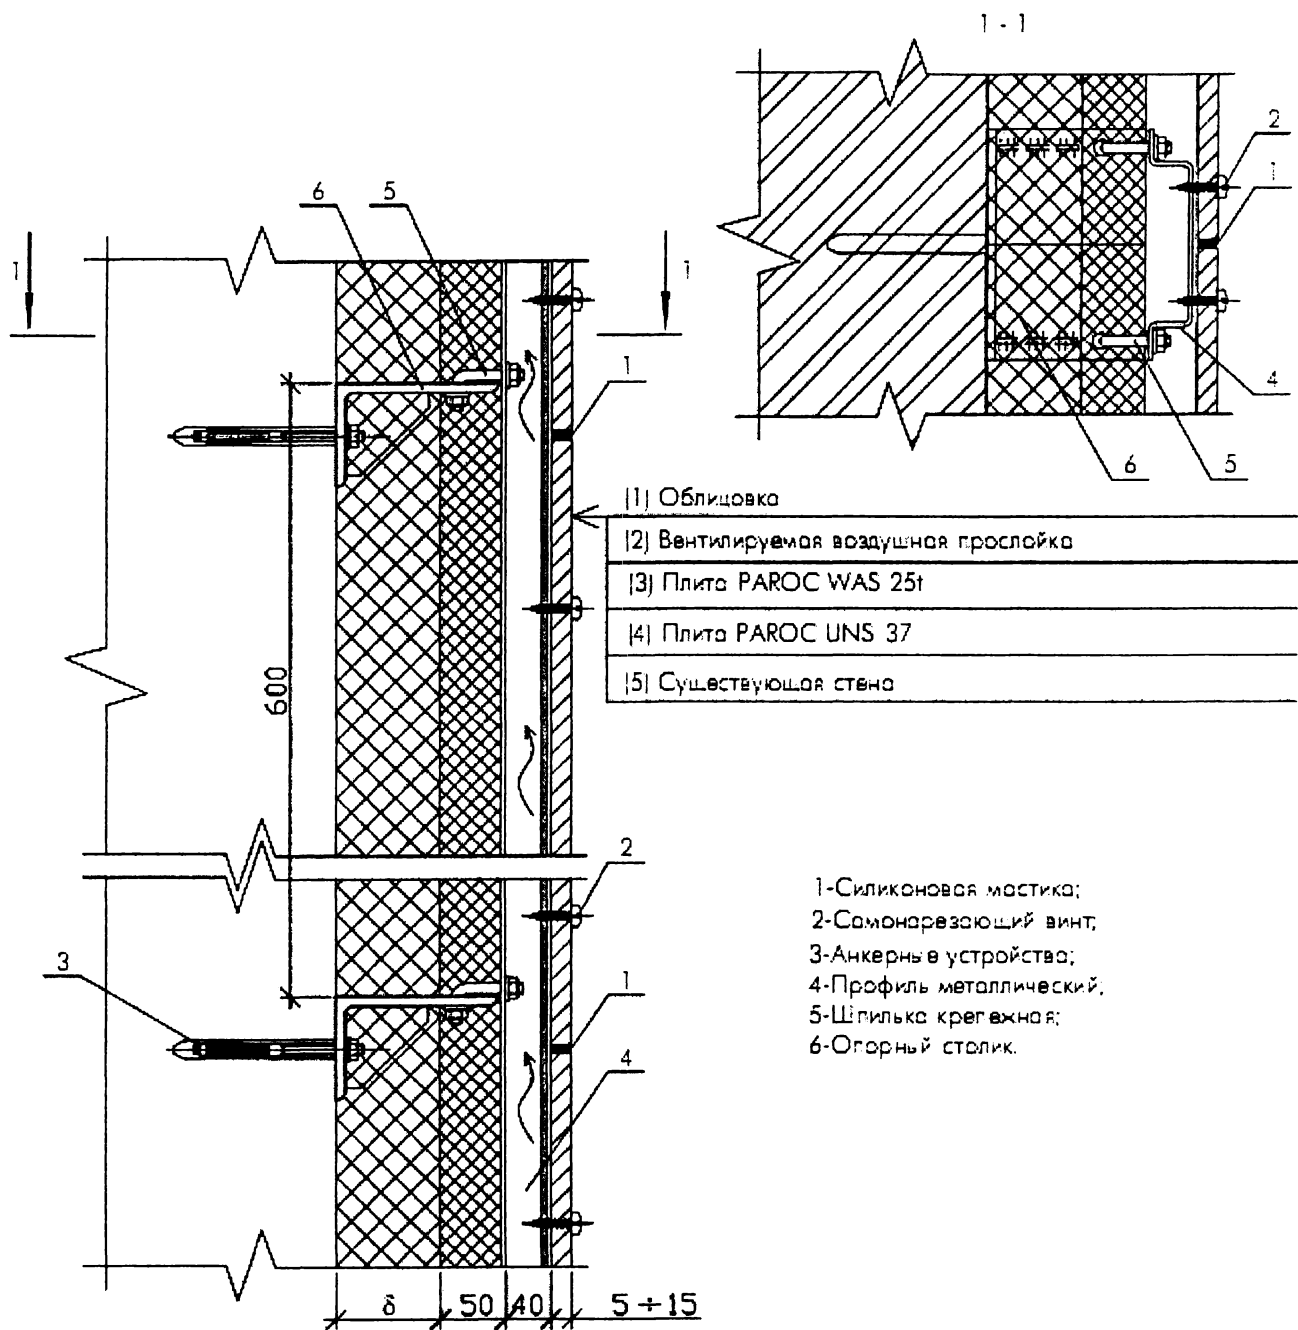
Вентилируемая система утепления стен с металлическим каркасом
